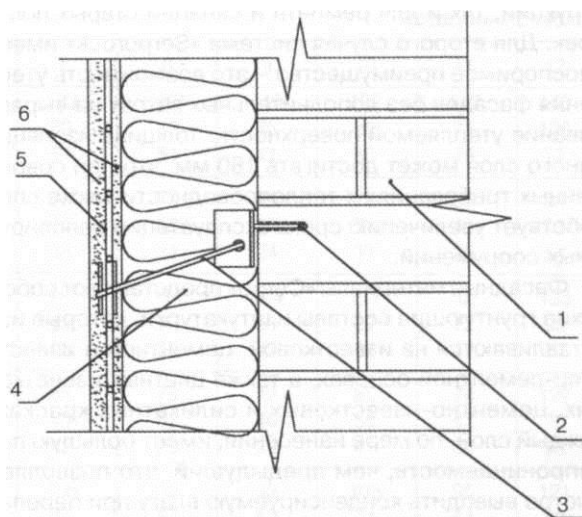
Схема утепления наружной стены: 1 - наружная стена; 2 - анкер распорный; 3 - подвижный элемент крепления; 4 - плиты теплоизоляционные; 5 - армирующая сетка; 6 - штукатурное покрытие
